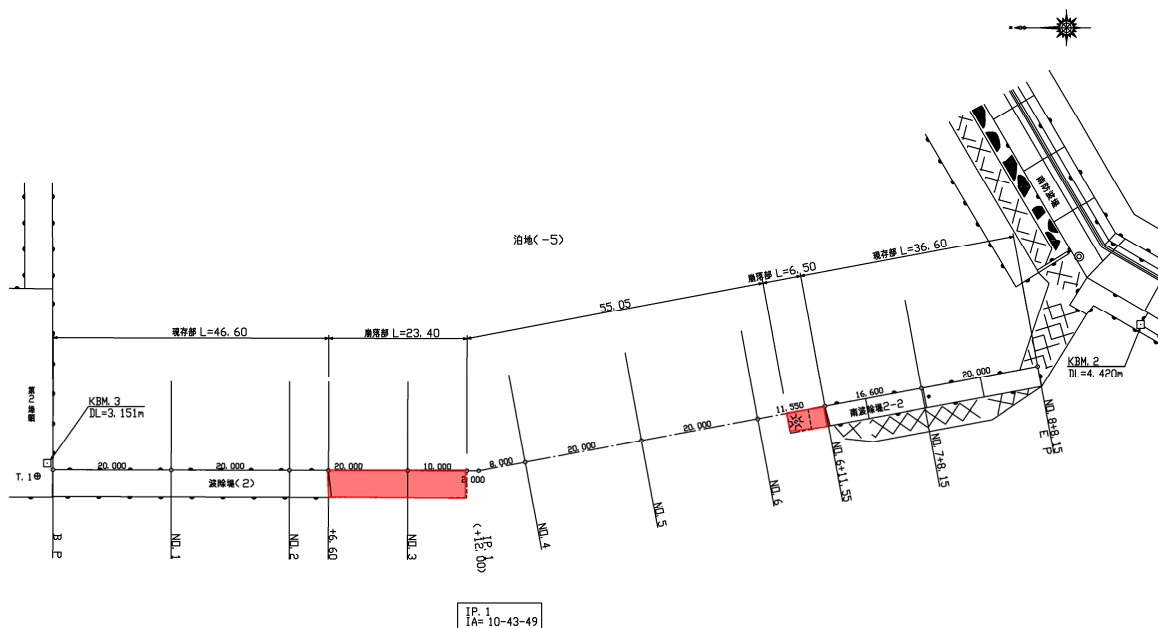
No.6 大洗港区\_南波除堤の平面図（被災後）
